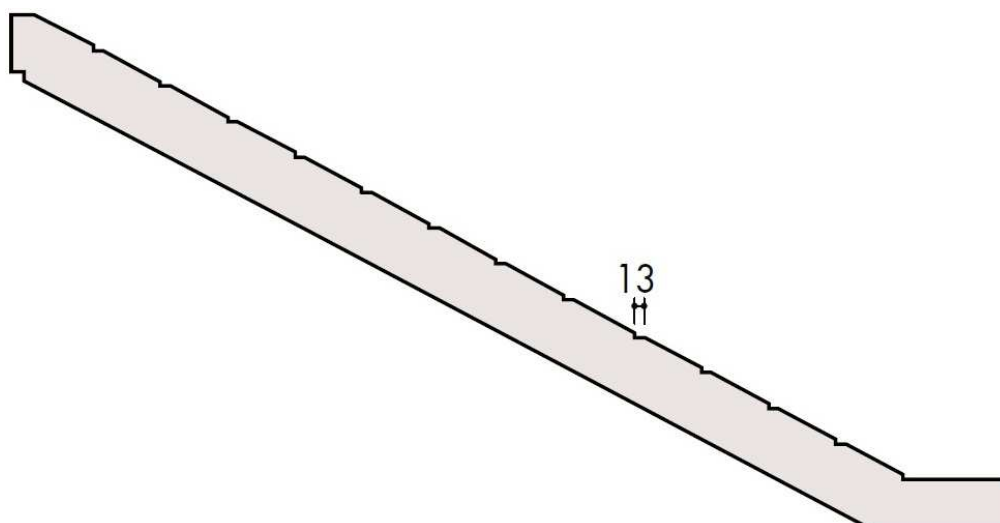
Geometría de la viga inclinada del pórtico porta-gradas (dimensiones en cm)
